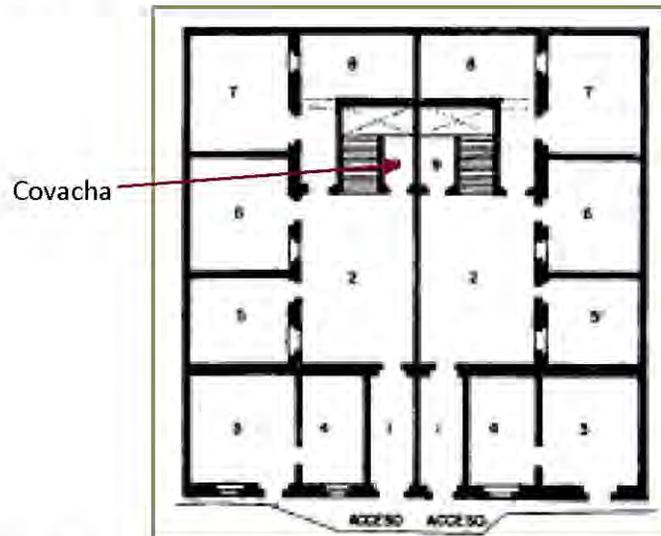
Planta baja de una casa en la calle de Perpetua, 1788.
